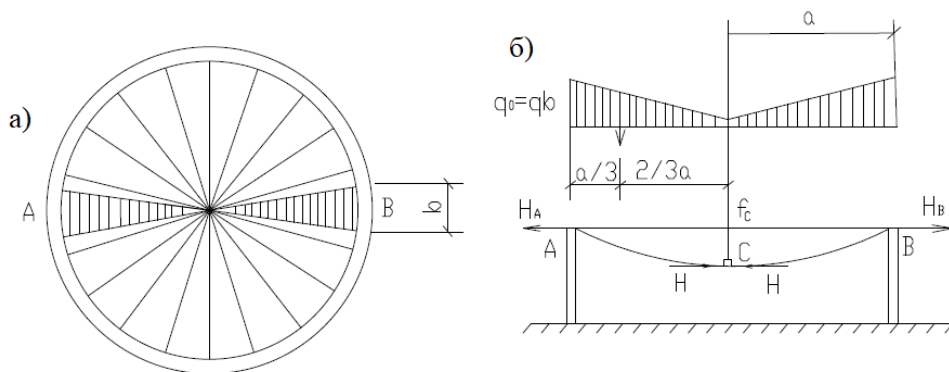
К расчету висячего покрытия с радиальной системой вант (а – план; б - расчетная схема троса)
